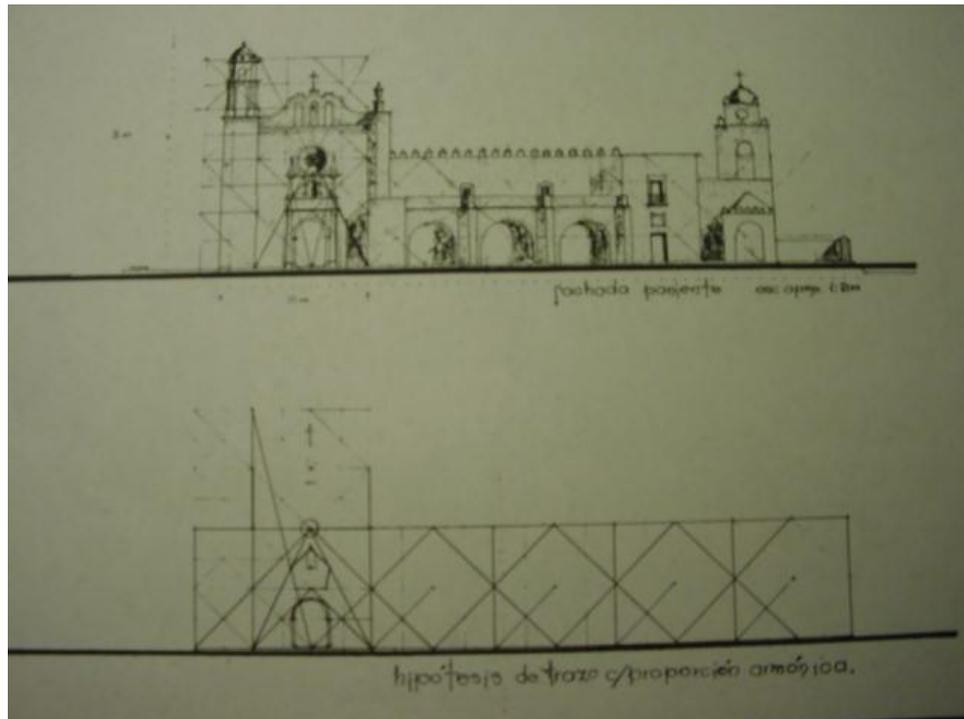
Estudio modular de la fachada poniente, San Guillermo Totolapan, Mor.
